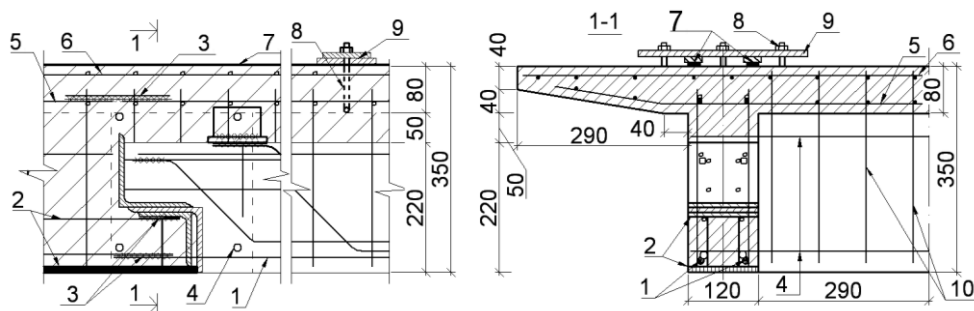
Схема конструкції стиків збірних і монолітних балок: 1 – збірна балка; 2 – арматурний каркас монолітної надопорної балки; 3 – зварний стик випусків поздовжньої арматури збірної балки і арматурного каркасу надопорної балки; 4 – арматура поперечної балки; 5,6 – нижня і верхня сітки плити С-1 і С-2; 7 – неметалева стрічкова арматура; 8 – закладні болти для анкерування кінців стрічок; 9 – деталь для анкерування кінців стрічки Sika CarboDur S212; 10 - хомути поперечної балки.
